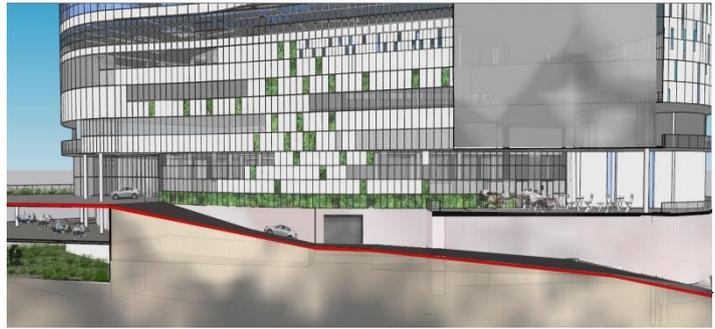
38 : coupe schématique sur la rampe d'accès principale
